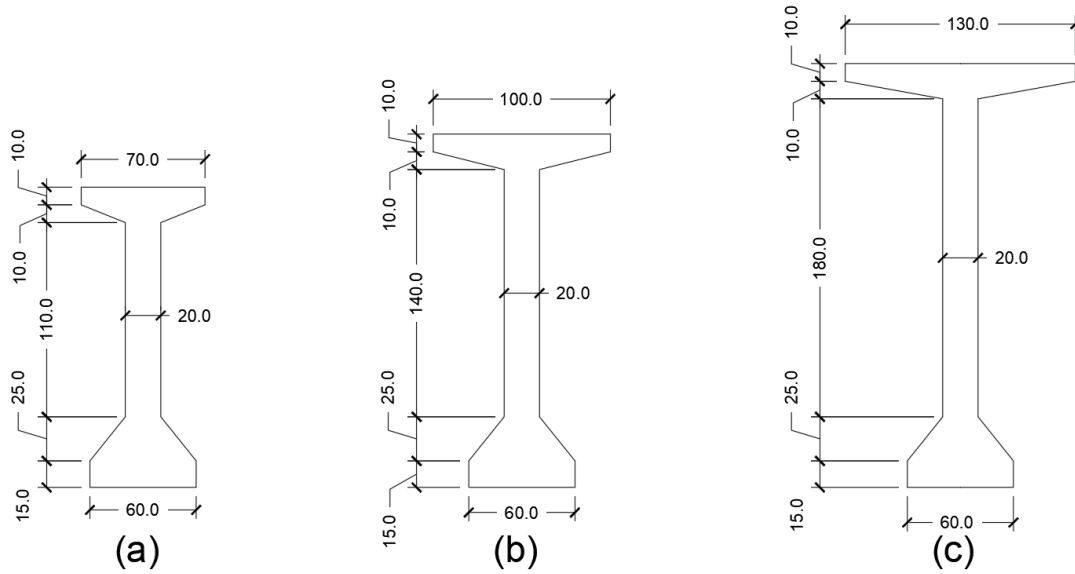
Seção transversal de vigas de concreto protendido: (a) vão de 20 m, (b) vão de 30 m, (c) vão de 40 m (dimensões em centímetros).
